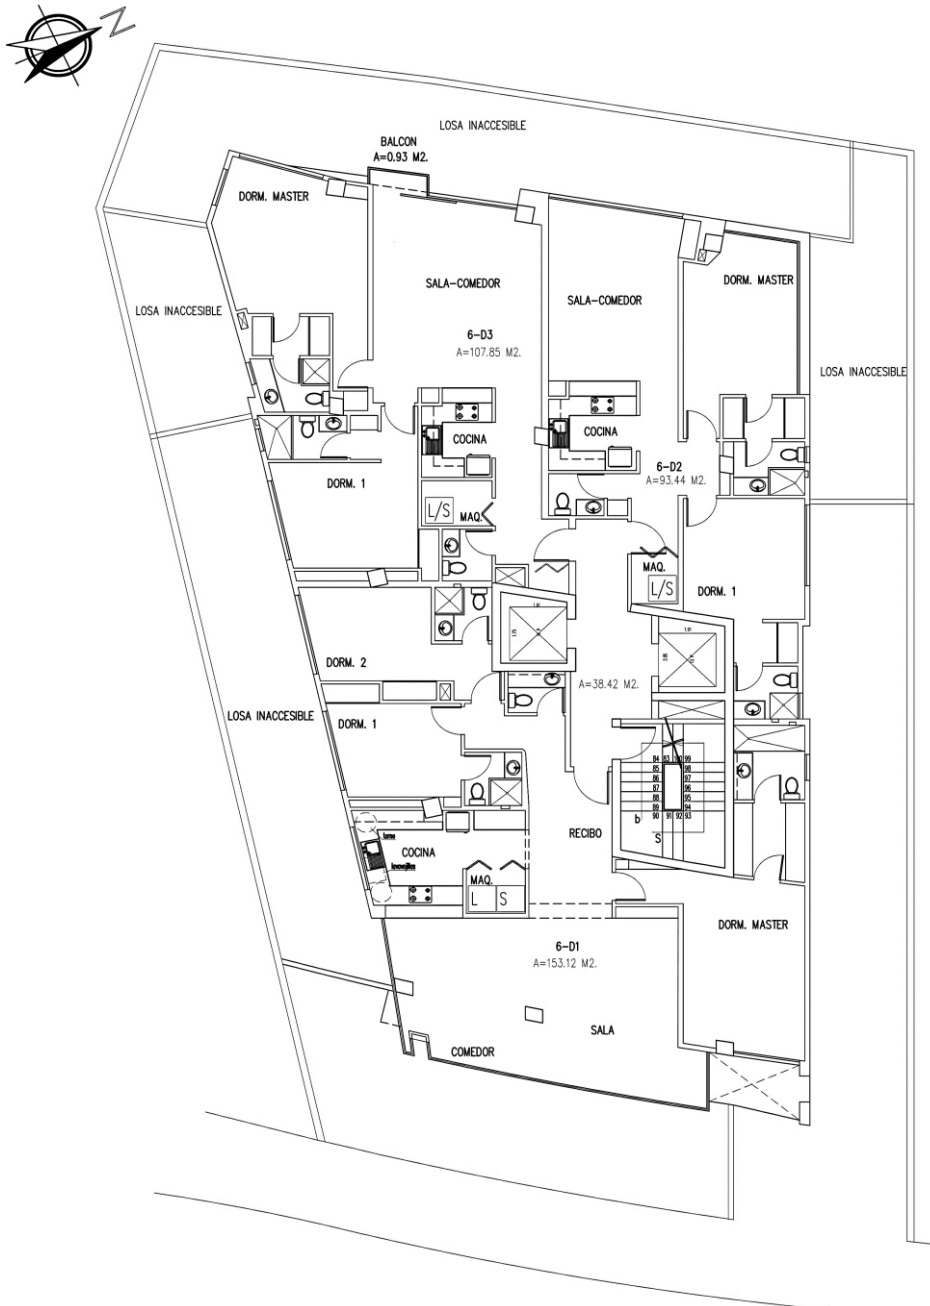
Planos Arquitectónicos Edificio Bohème – Planta 6, 7, 8,9
